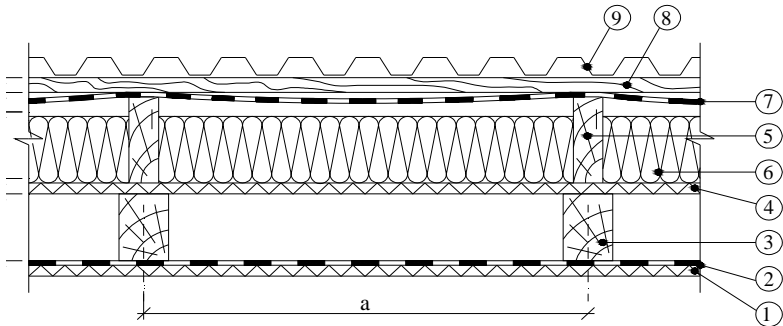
Схема «2». Вариант конструктивного решения устройства теплоизоляционного слоя и подкровельных пленок в конструкции покрытия. Утеплитель размещен над стропилами. Подшивка потолка располагается под стропильными ногами:
